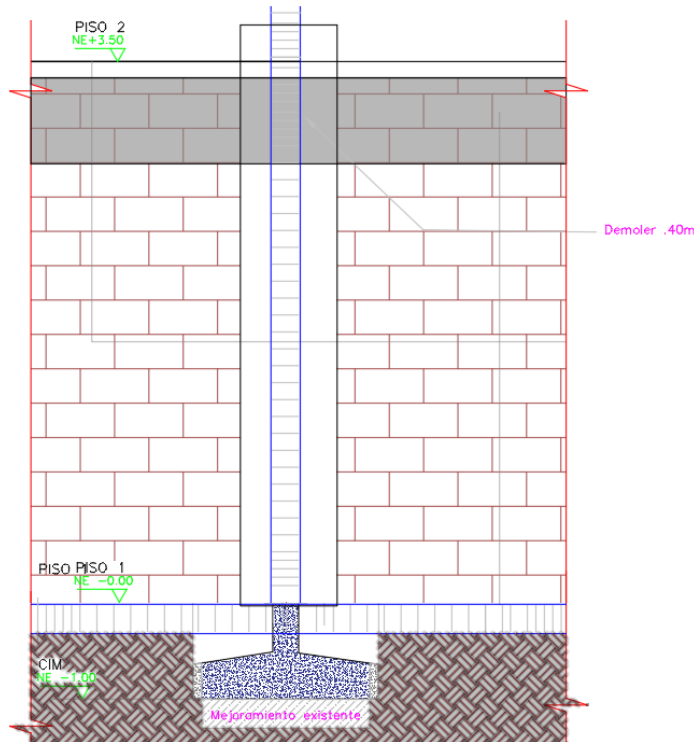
Demolición para Construcción de Vigas en Concreto.
